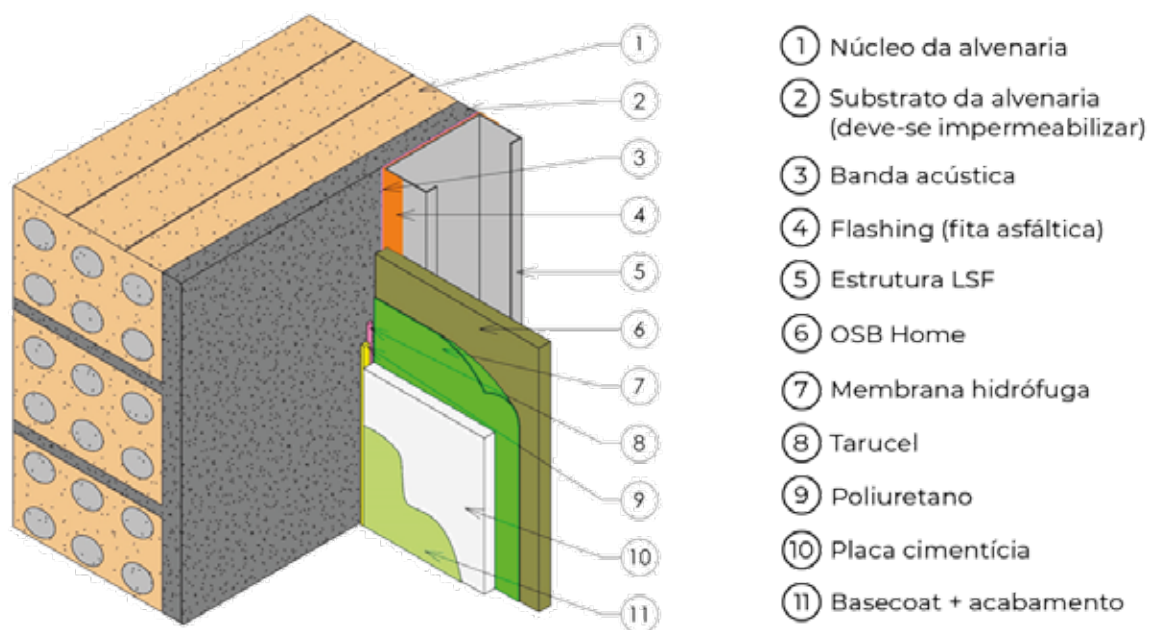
Parede LSF perpendicular a parede de alvenaria
